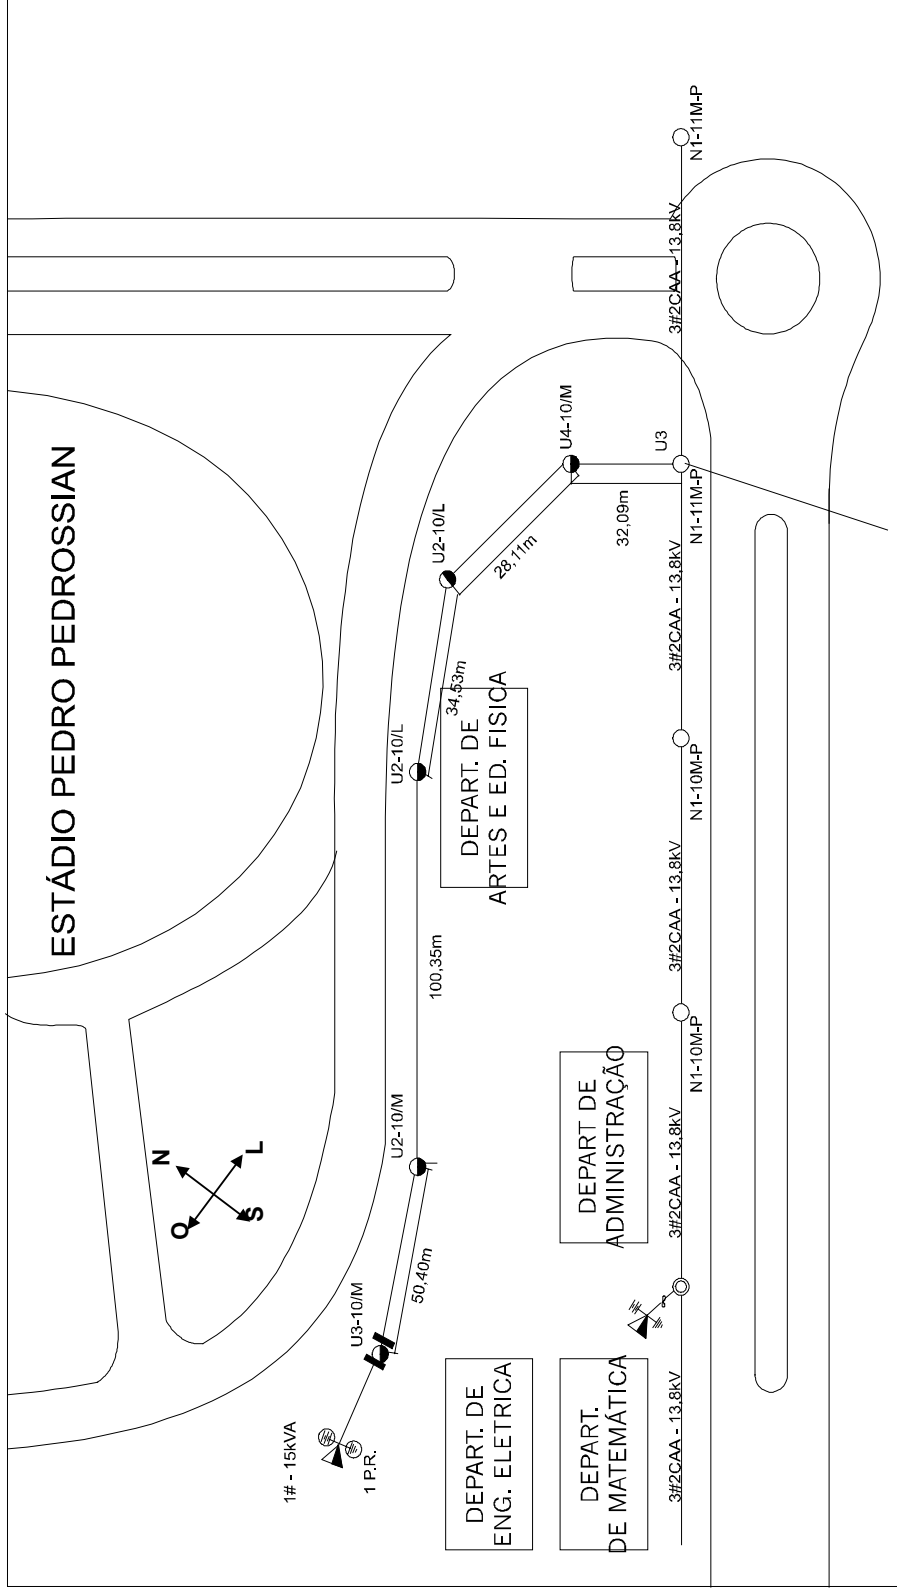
Croqui do Sistema MRT instalado na UFMS
